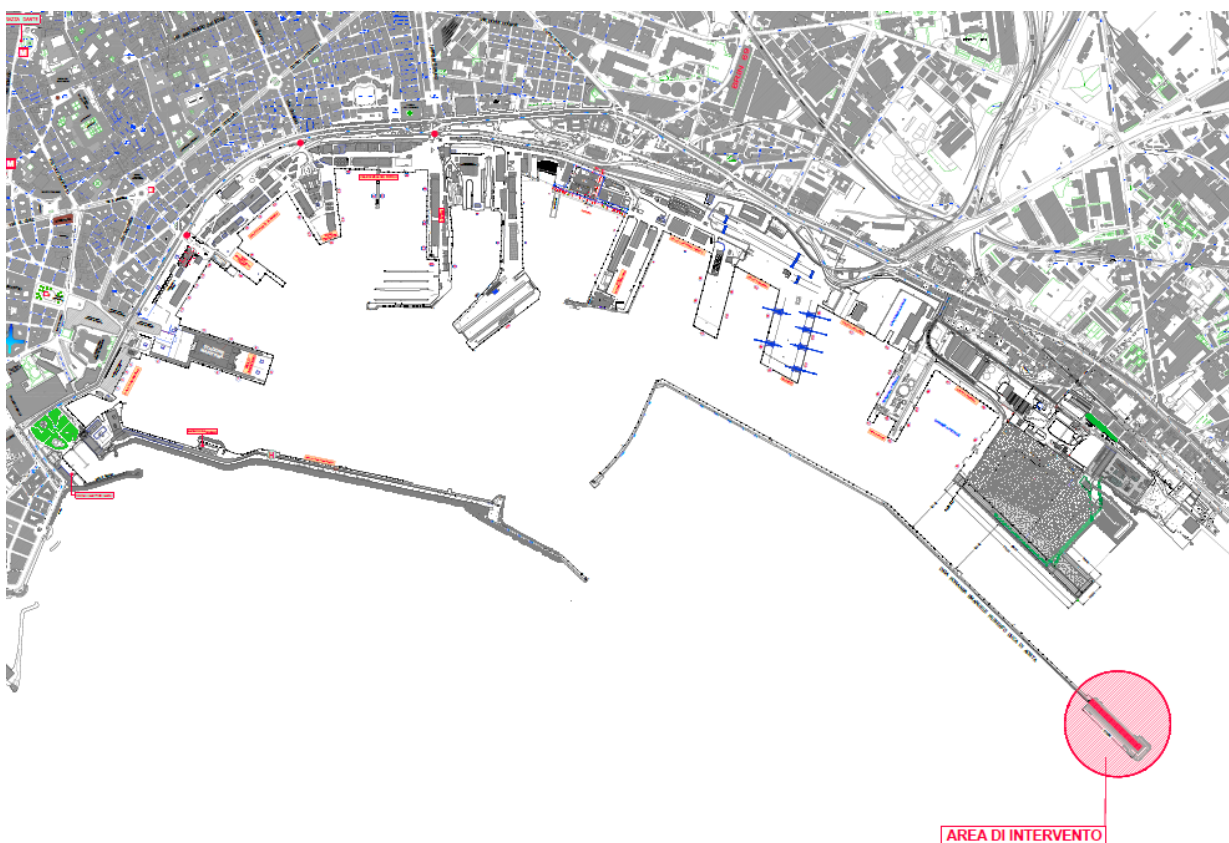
Planimetria di ubicazione dell'area logistica di cantiere .....	70
